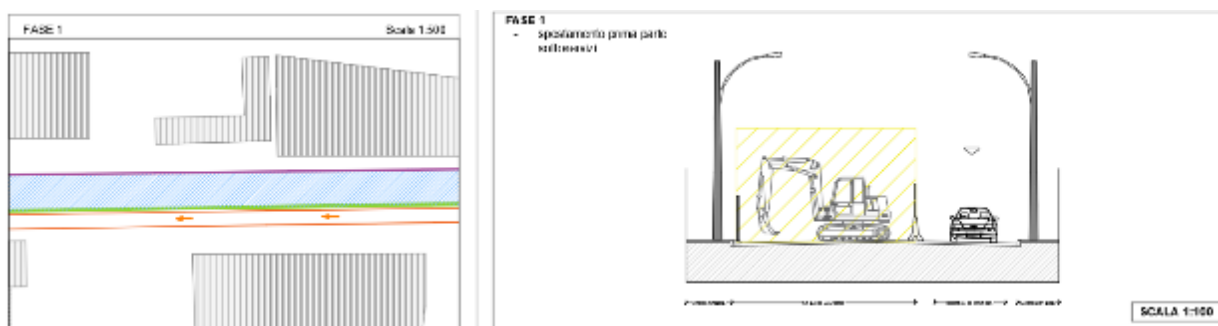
Tipologico cantiere con sede laterale Fase 1
